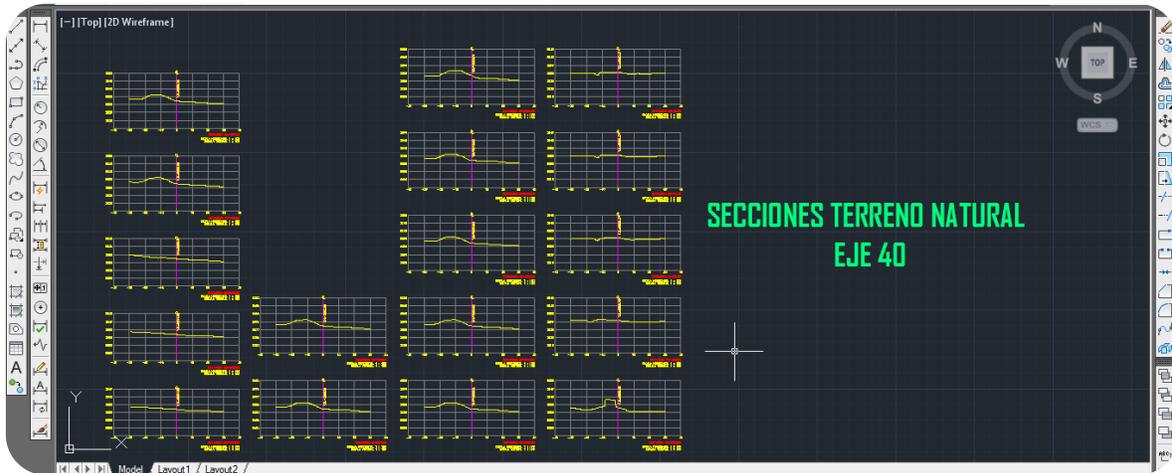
Secciones transversales del terreno natural Eje 40. Fuente: Propia.
